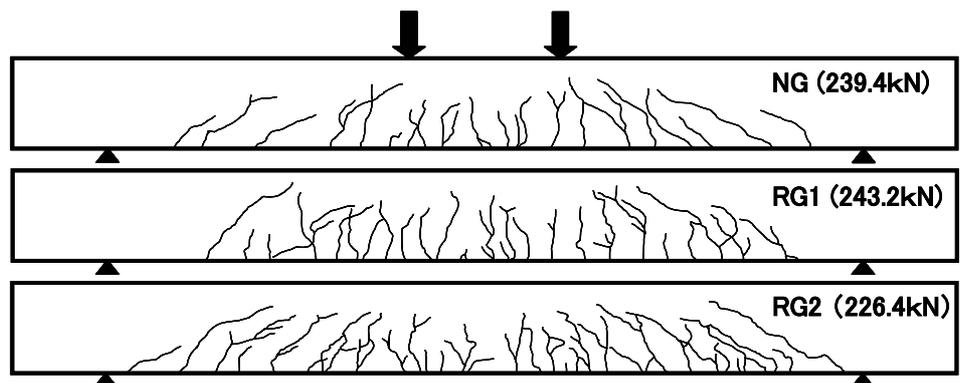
RC はりのひび割れ発生状況(200kN 載荷時)
